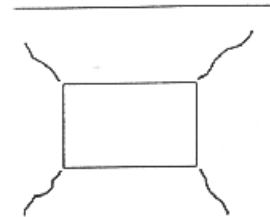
FISSURAÇÃO nos cantos de janelas Faltam vergas e contravergas
